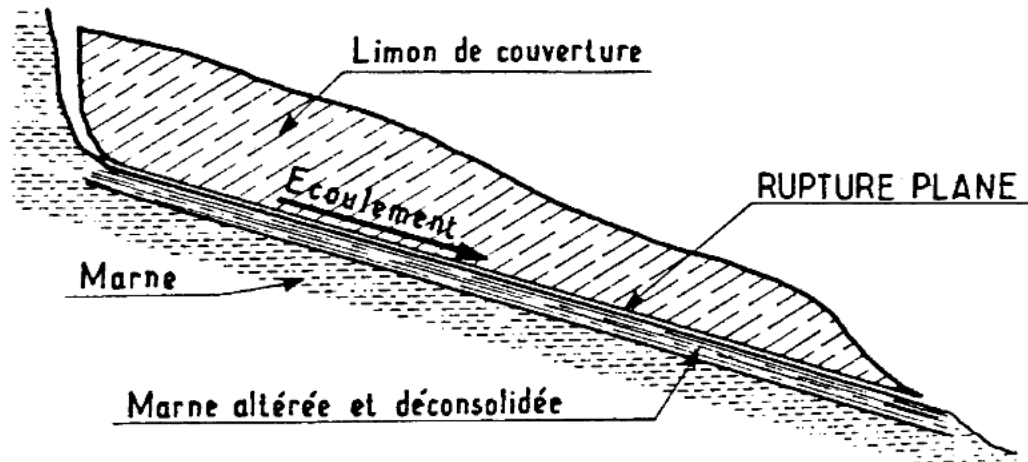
illustration d'un glissement plan sur une couche savon[3].
